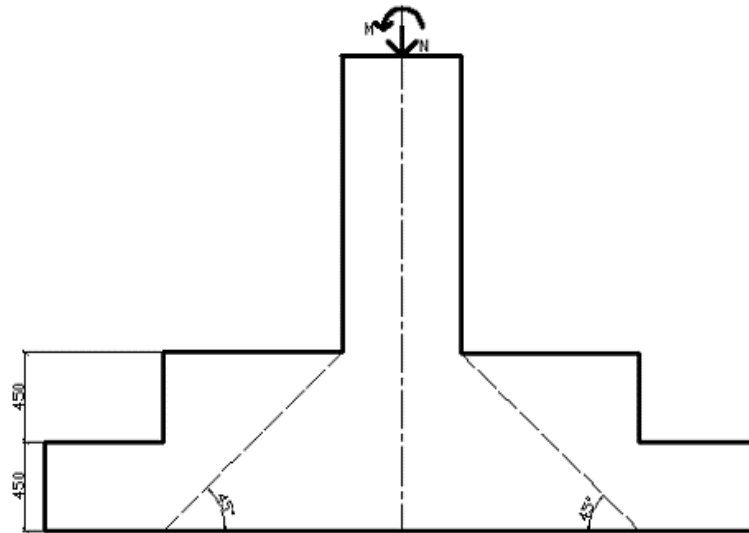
Схема до розрахунку симетричного високого фундаменту на продавлювання підколонником
